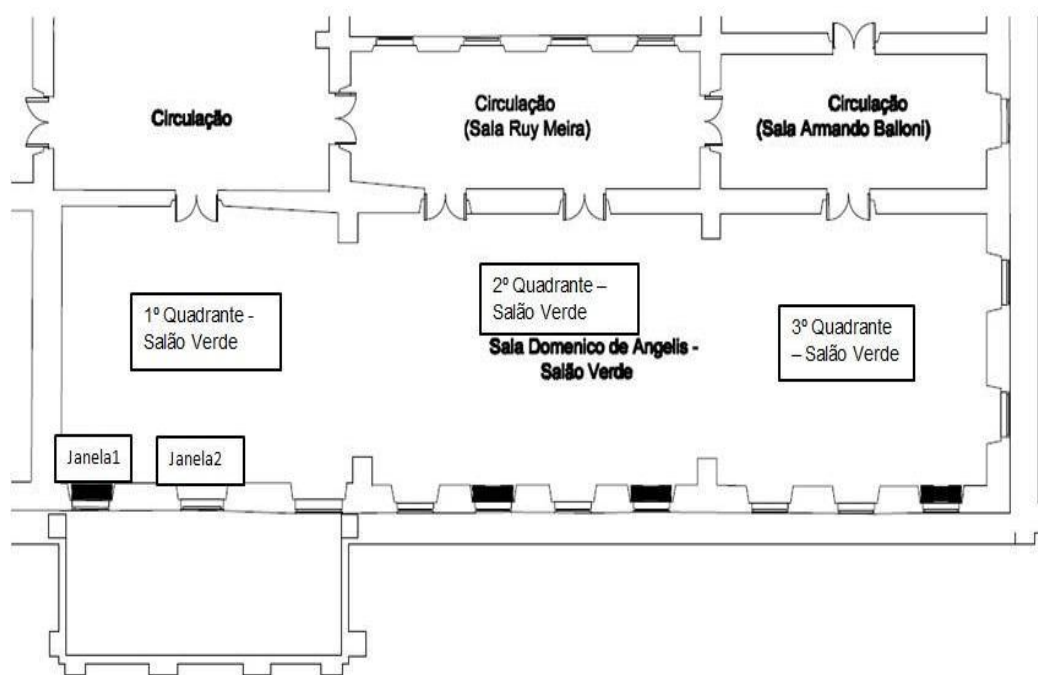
Planta baixa com localização das janelas e quadrantes citados.
